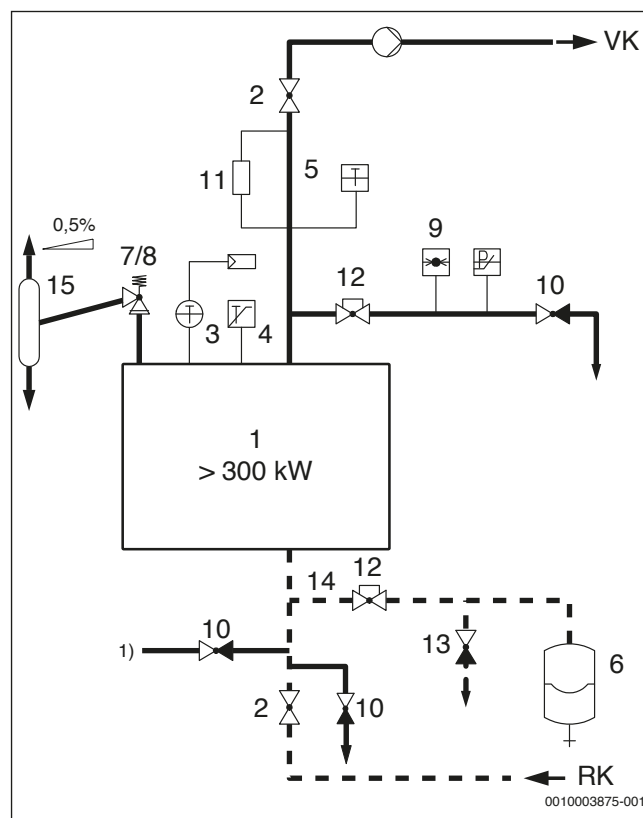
Equipaggiamento tecnico di sicurezza UNI EN 12828 per caldaia > 300 kW
